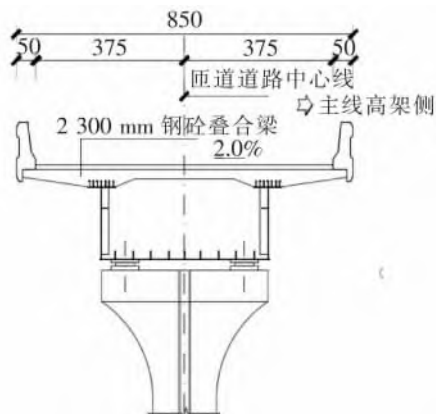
40 m 标准跨径桥梁横断面(单位:cm)
